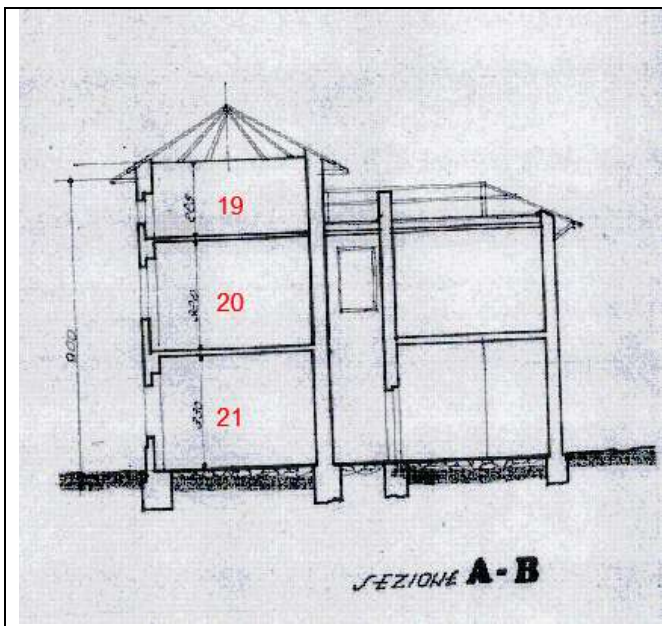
estratto dalla Licenza Edilizia n.2/1978 - piano T-1-2 con individuazione delle non conformità
